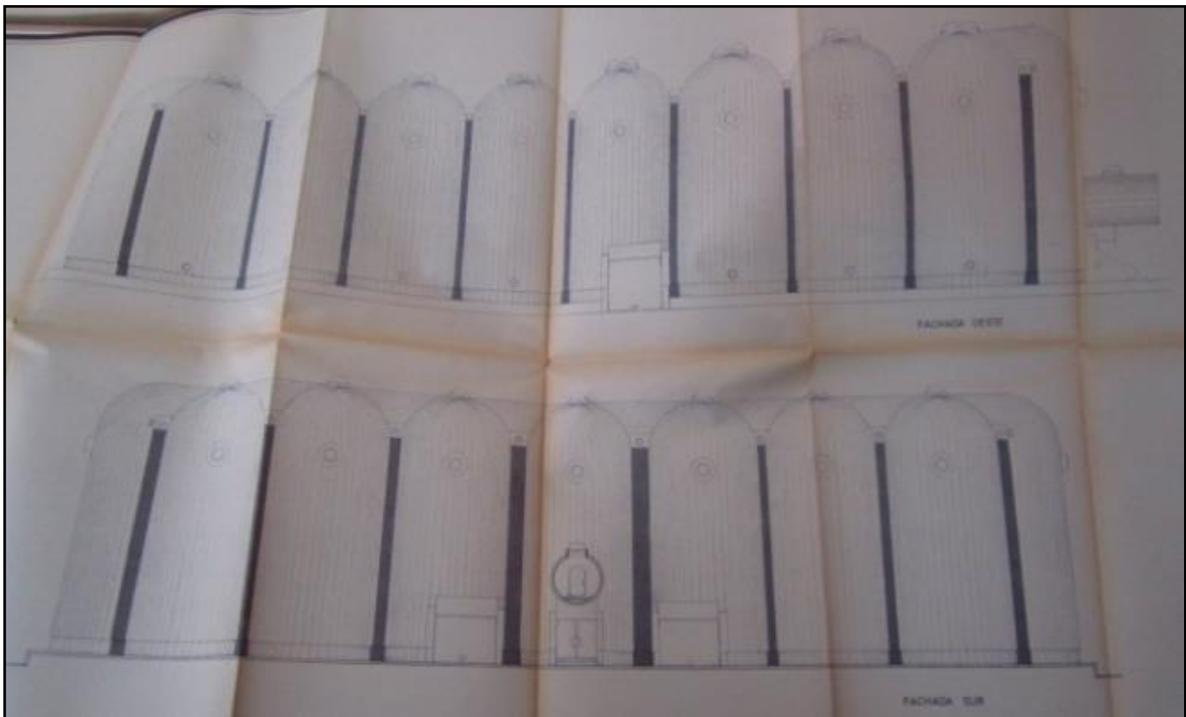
Plano nº19 de los alzados Oeste y Sur del proyecto original. (Fuente: AMA)
